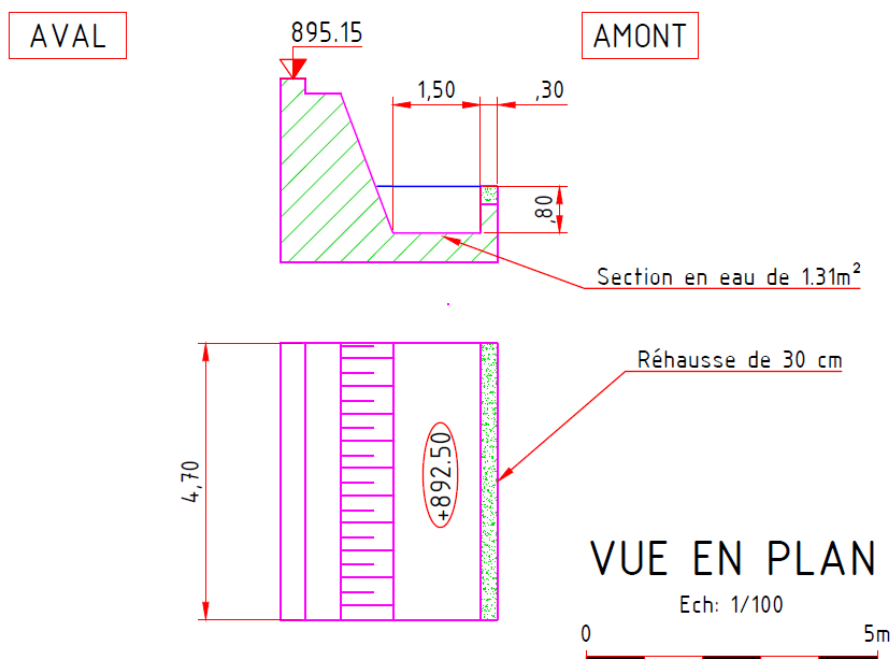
Plan du barrage de la Bédoule et de la rehausse
